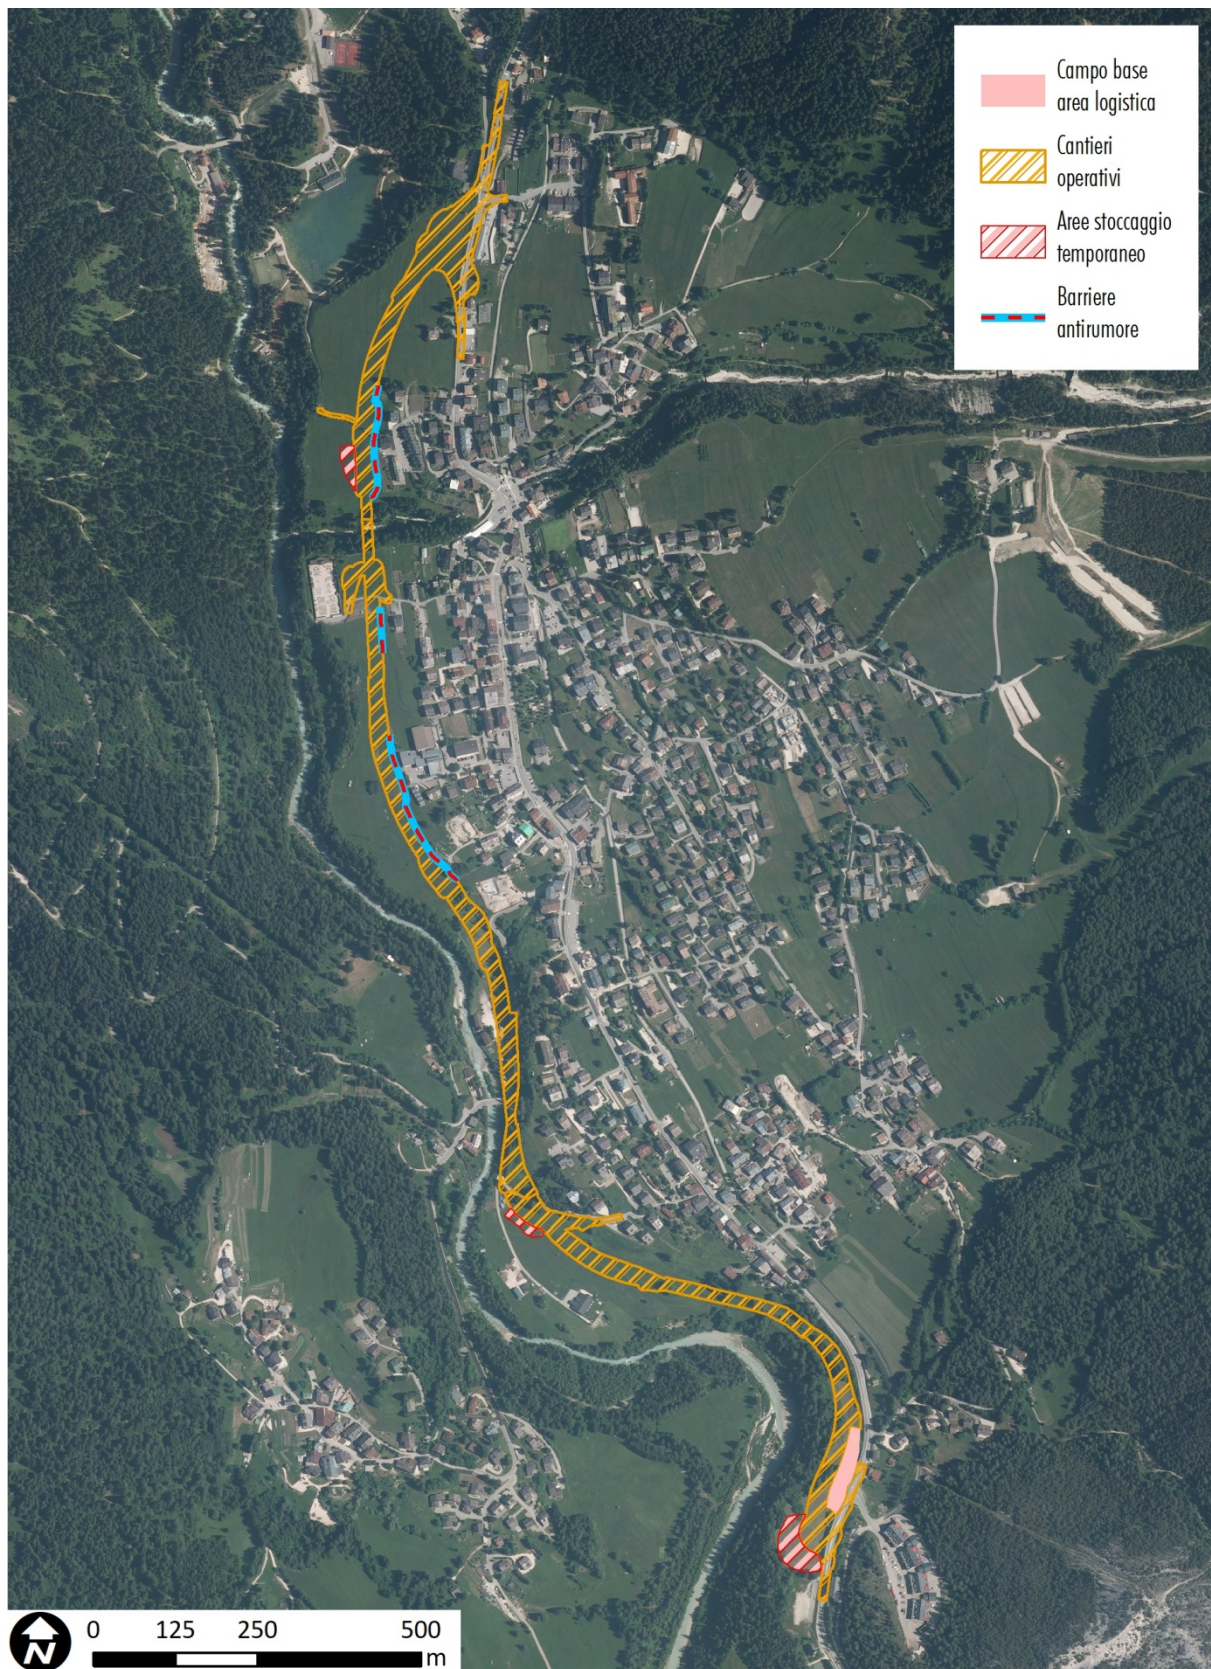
Ubicazione delle barriere fonoassorbenti nelle aree di cantiere.
